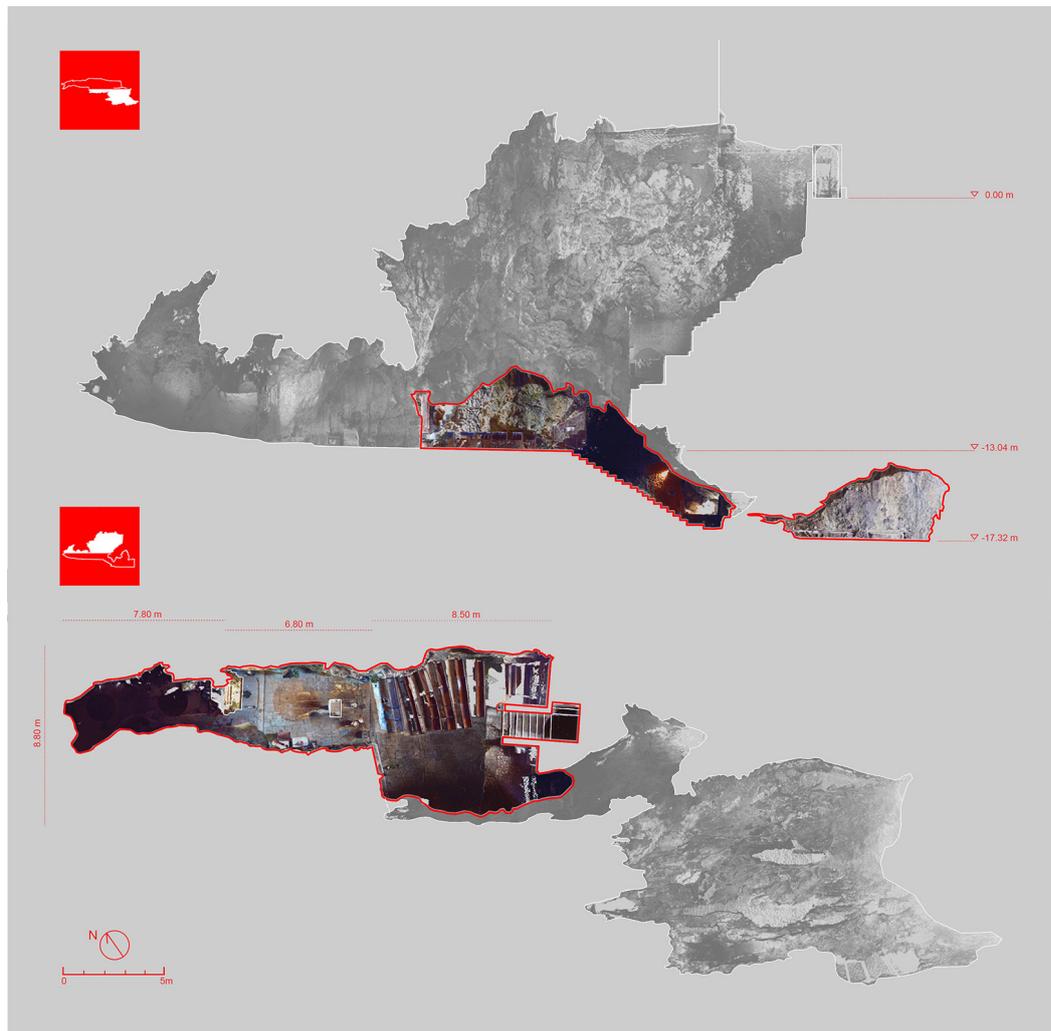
Eremito di Santa Maria della Stella, Pazzano. Sezione longitudinale sulla scala di collegamento tra i due livelli. Pianta a quota -11.00 m (in basso). Elaborazione grafica di Placido Pellicano.
